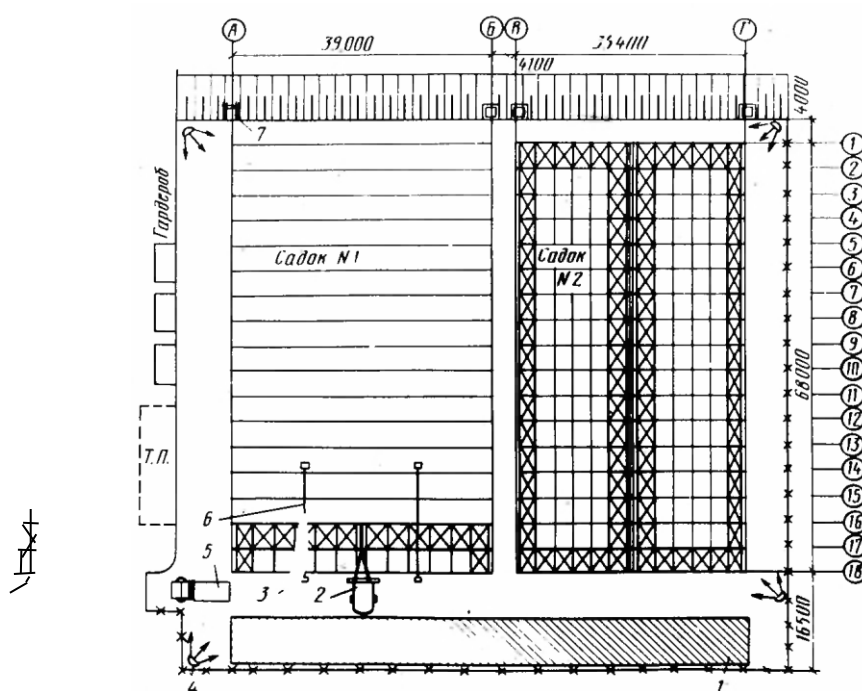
Стройгенплан на период монтажа укрытий живорыбных садков в Белгороде:
